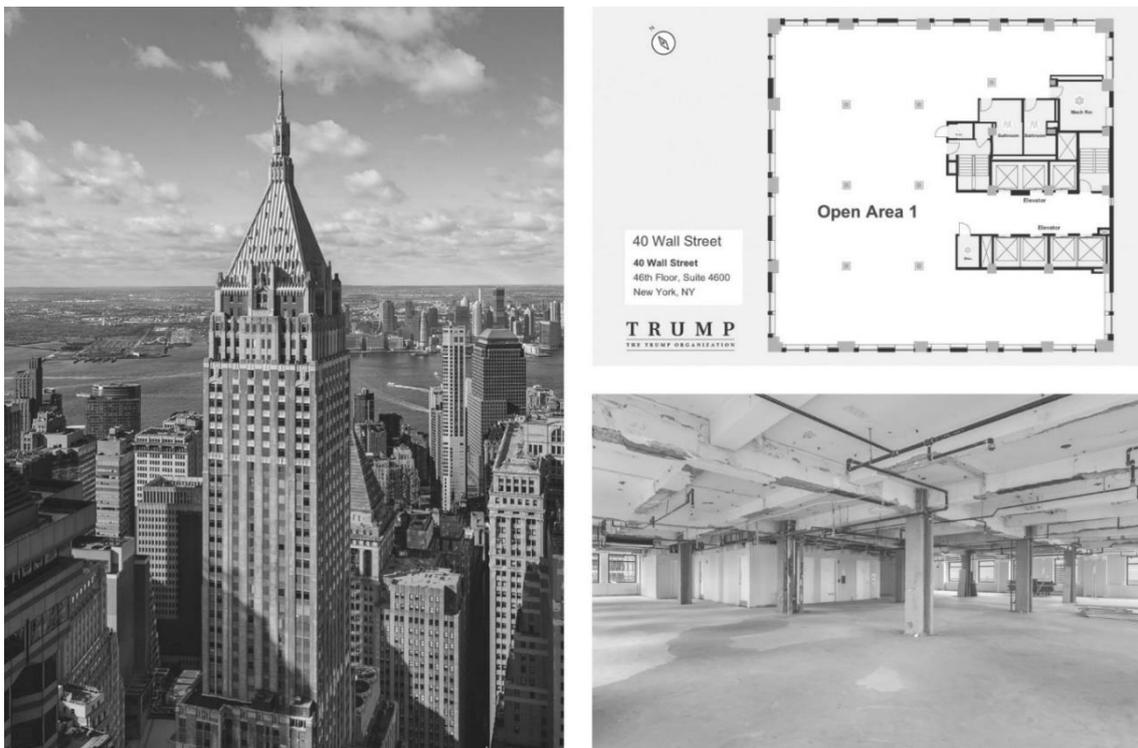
The Trump Building* или *40 Wall Street* (Нью-Йорк, 1930 г., 282,6 м)
